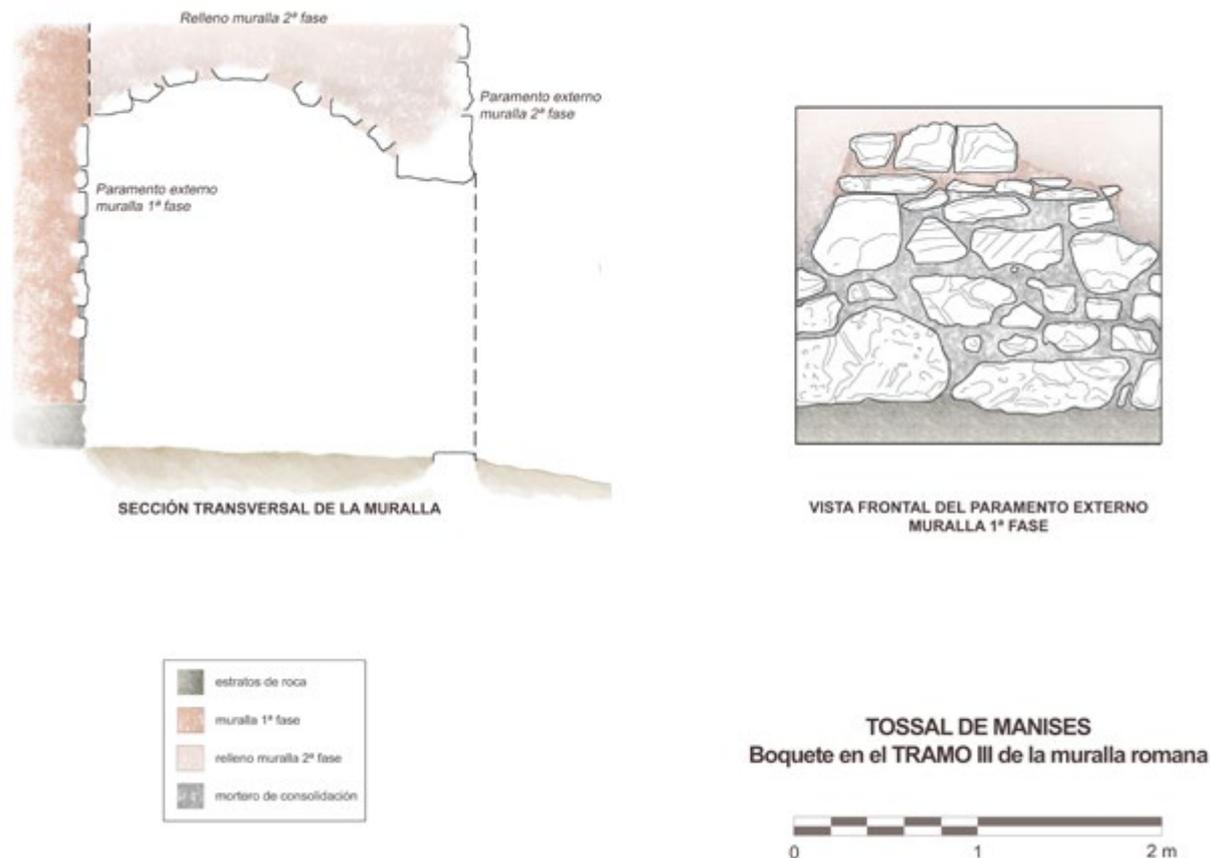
Sección y alzado interior del hueco de la muralla del tramo 3.
